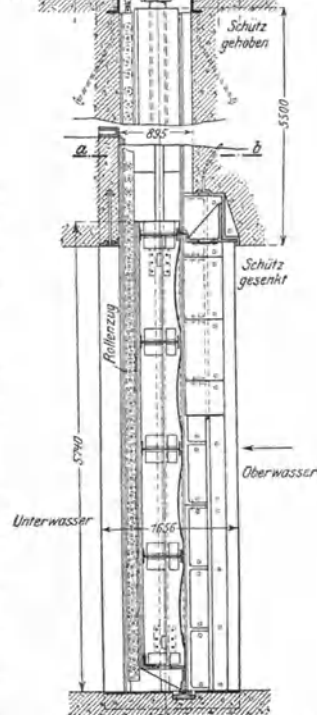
c. Panamaschützen. Maßstab 1:100.
